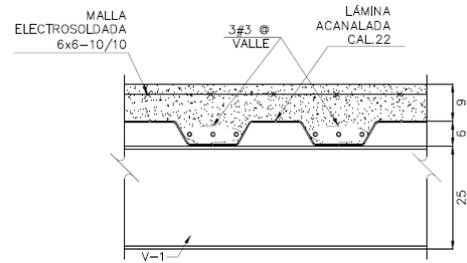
Detalle de firme sobre acero estructural tipo IR.
